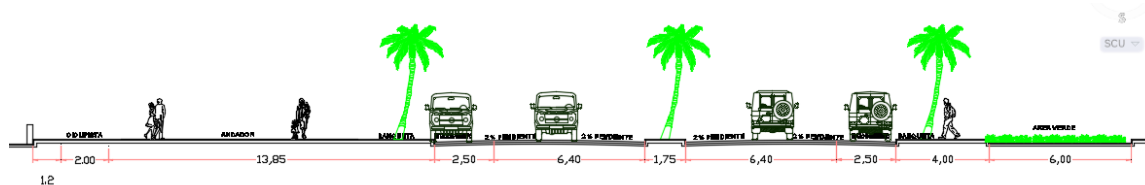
Corte transversal del proyecto (se anexa plano para mayor detalle).
